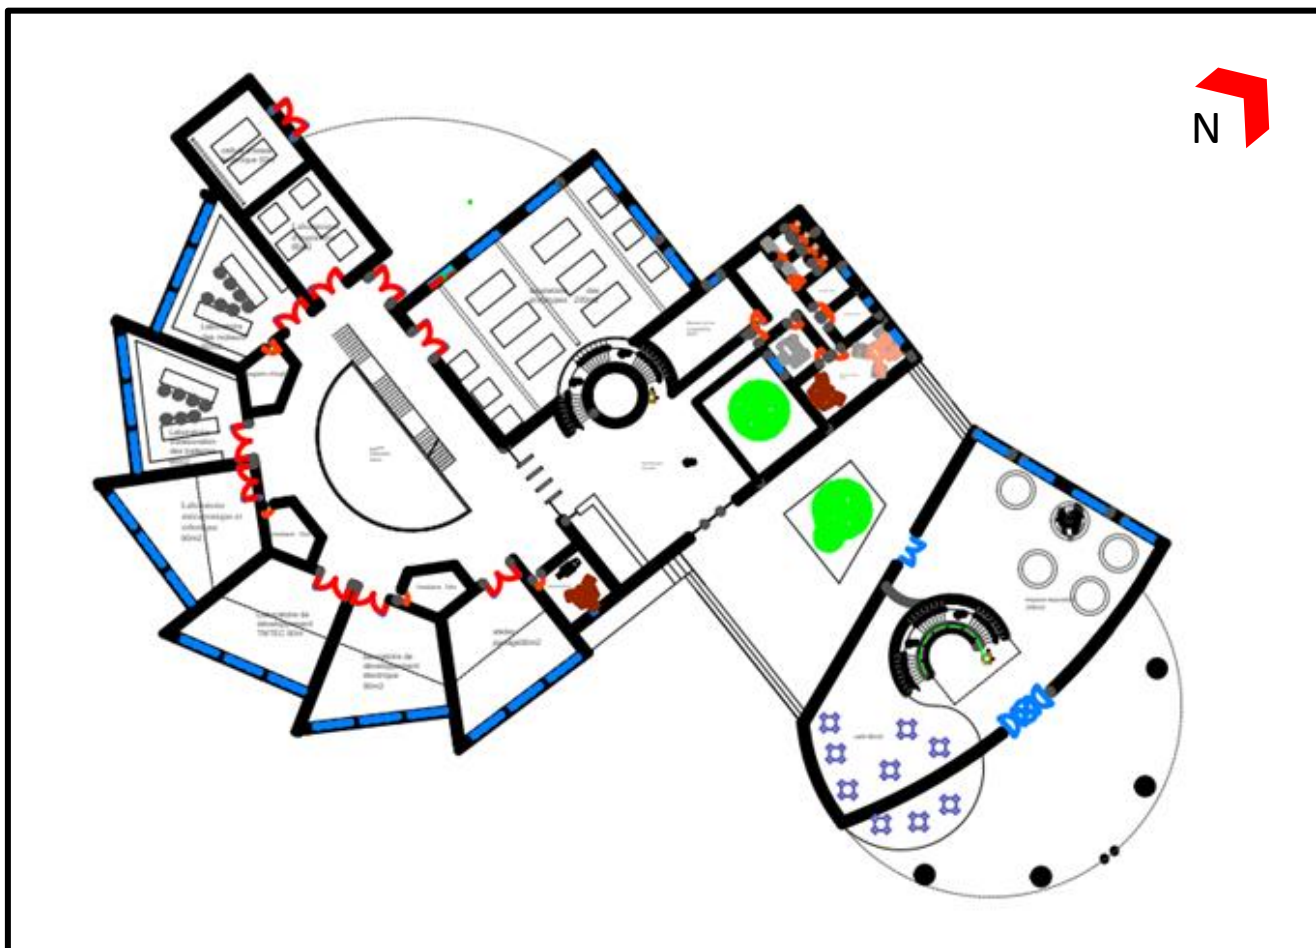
plan de rez-de-chaussée - niveau +0.50m
